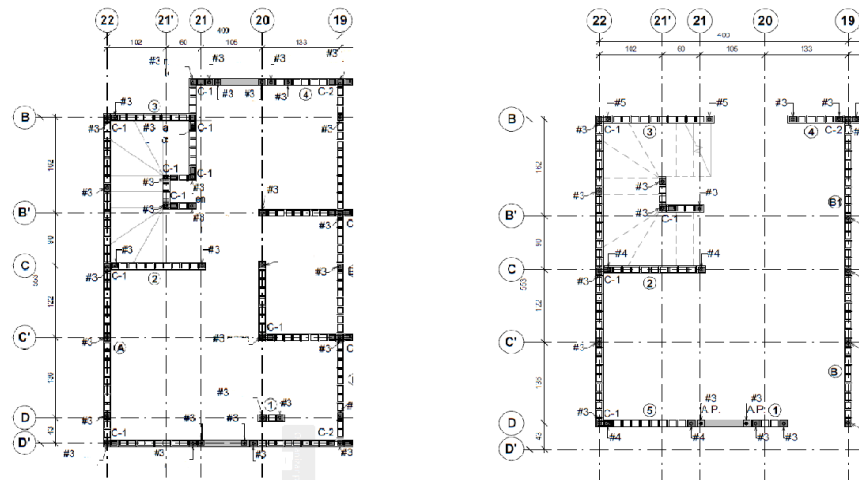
Planta Estructural de producto inmobiliario, Proyecto Manzanares (Constructora Bolívar, 2019).
